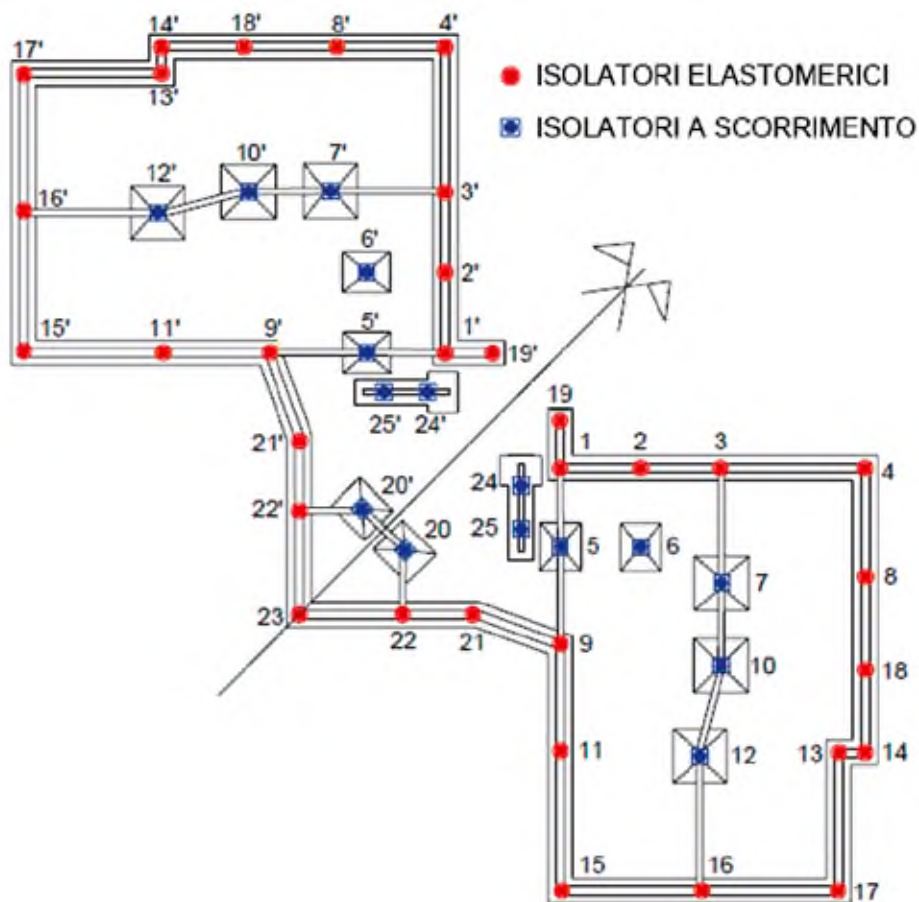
Pianta fondazioni e disposizione degli isolatori
